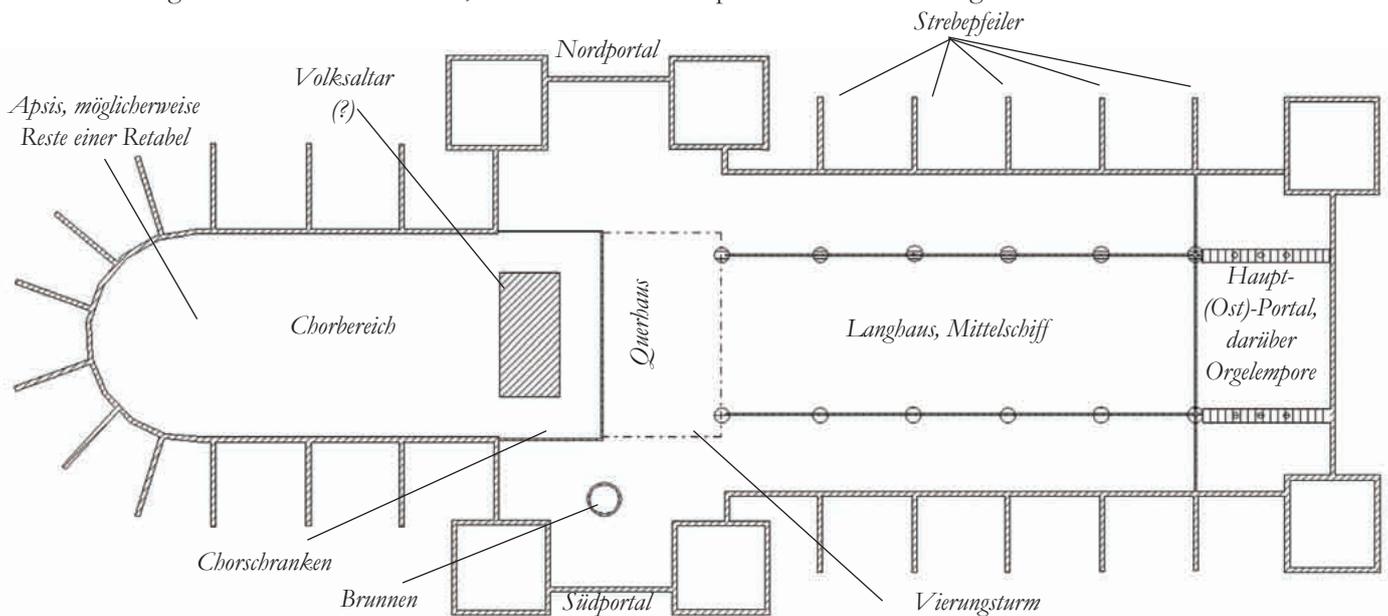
Der Grundriss des Münsters zu Entenhausen (Rekonstruktion nach den erschlossenen Maßen: Wessely)
